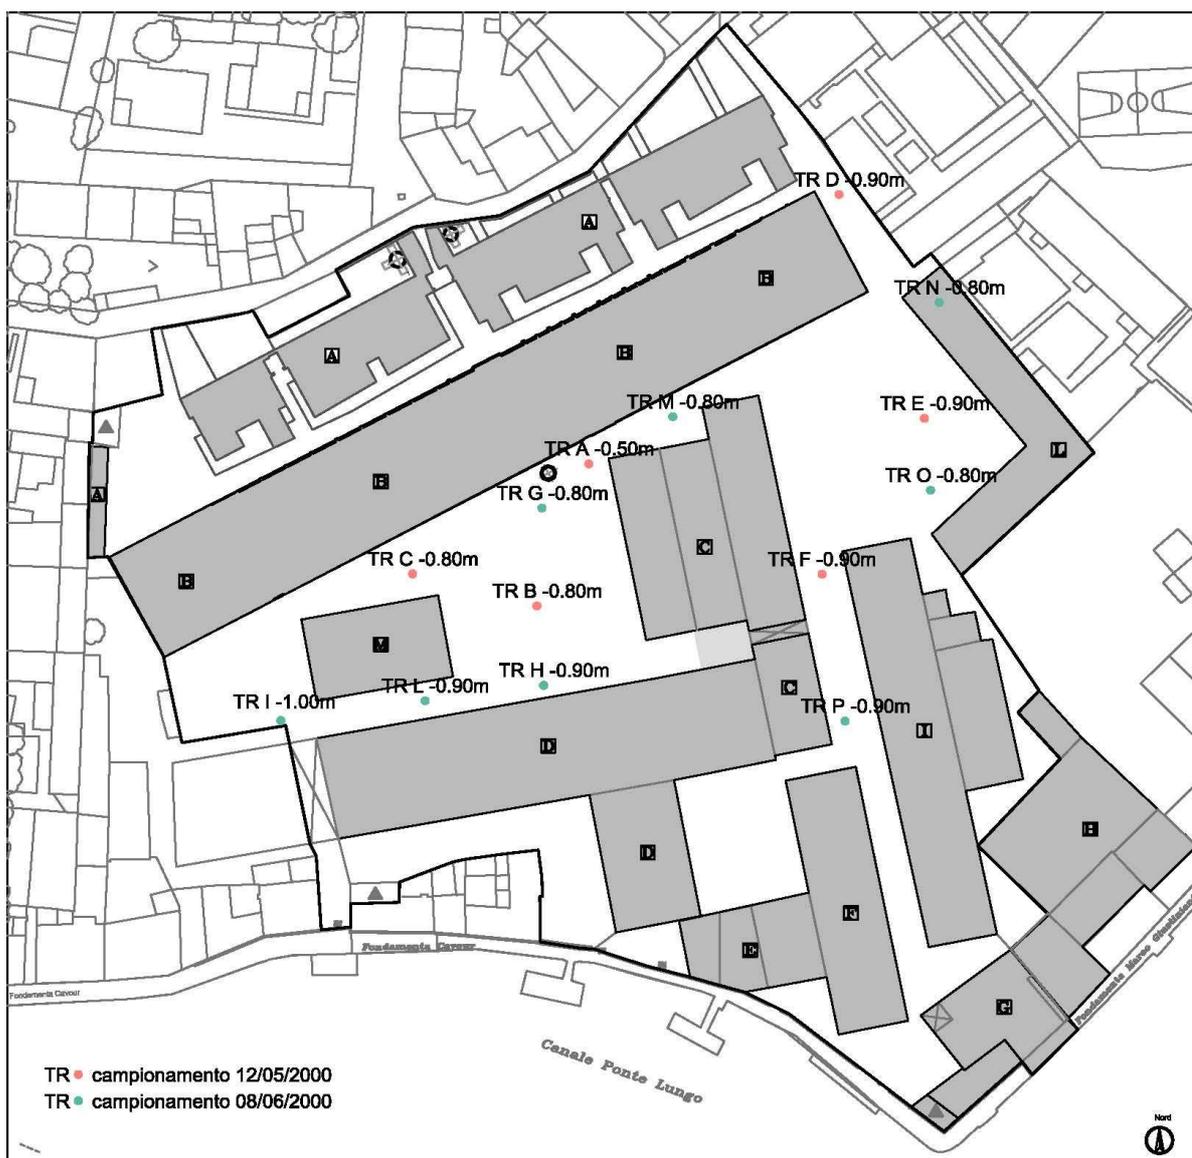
Rilievo dei livelli di falda nelle trincee. Campionamenti durante l'esecuzione del Piano di Caratterizzazione (12/05/2000 e 08/06/2000)
